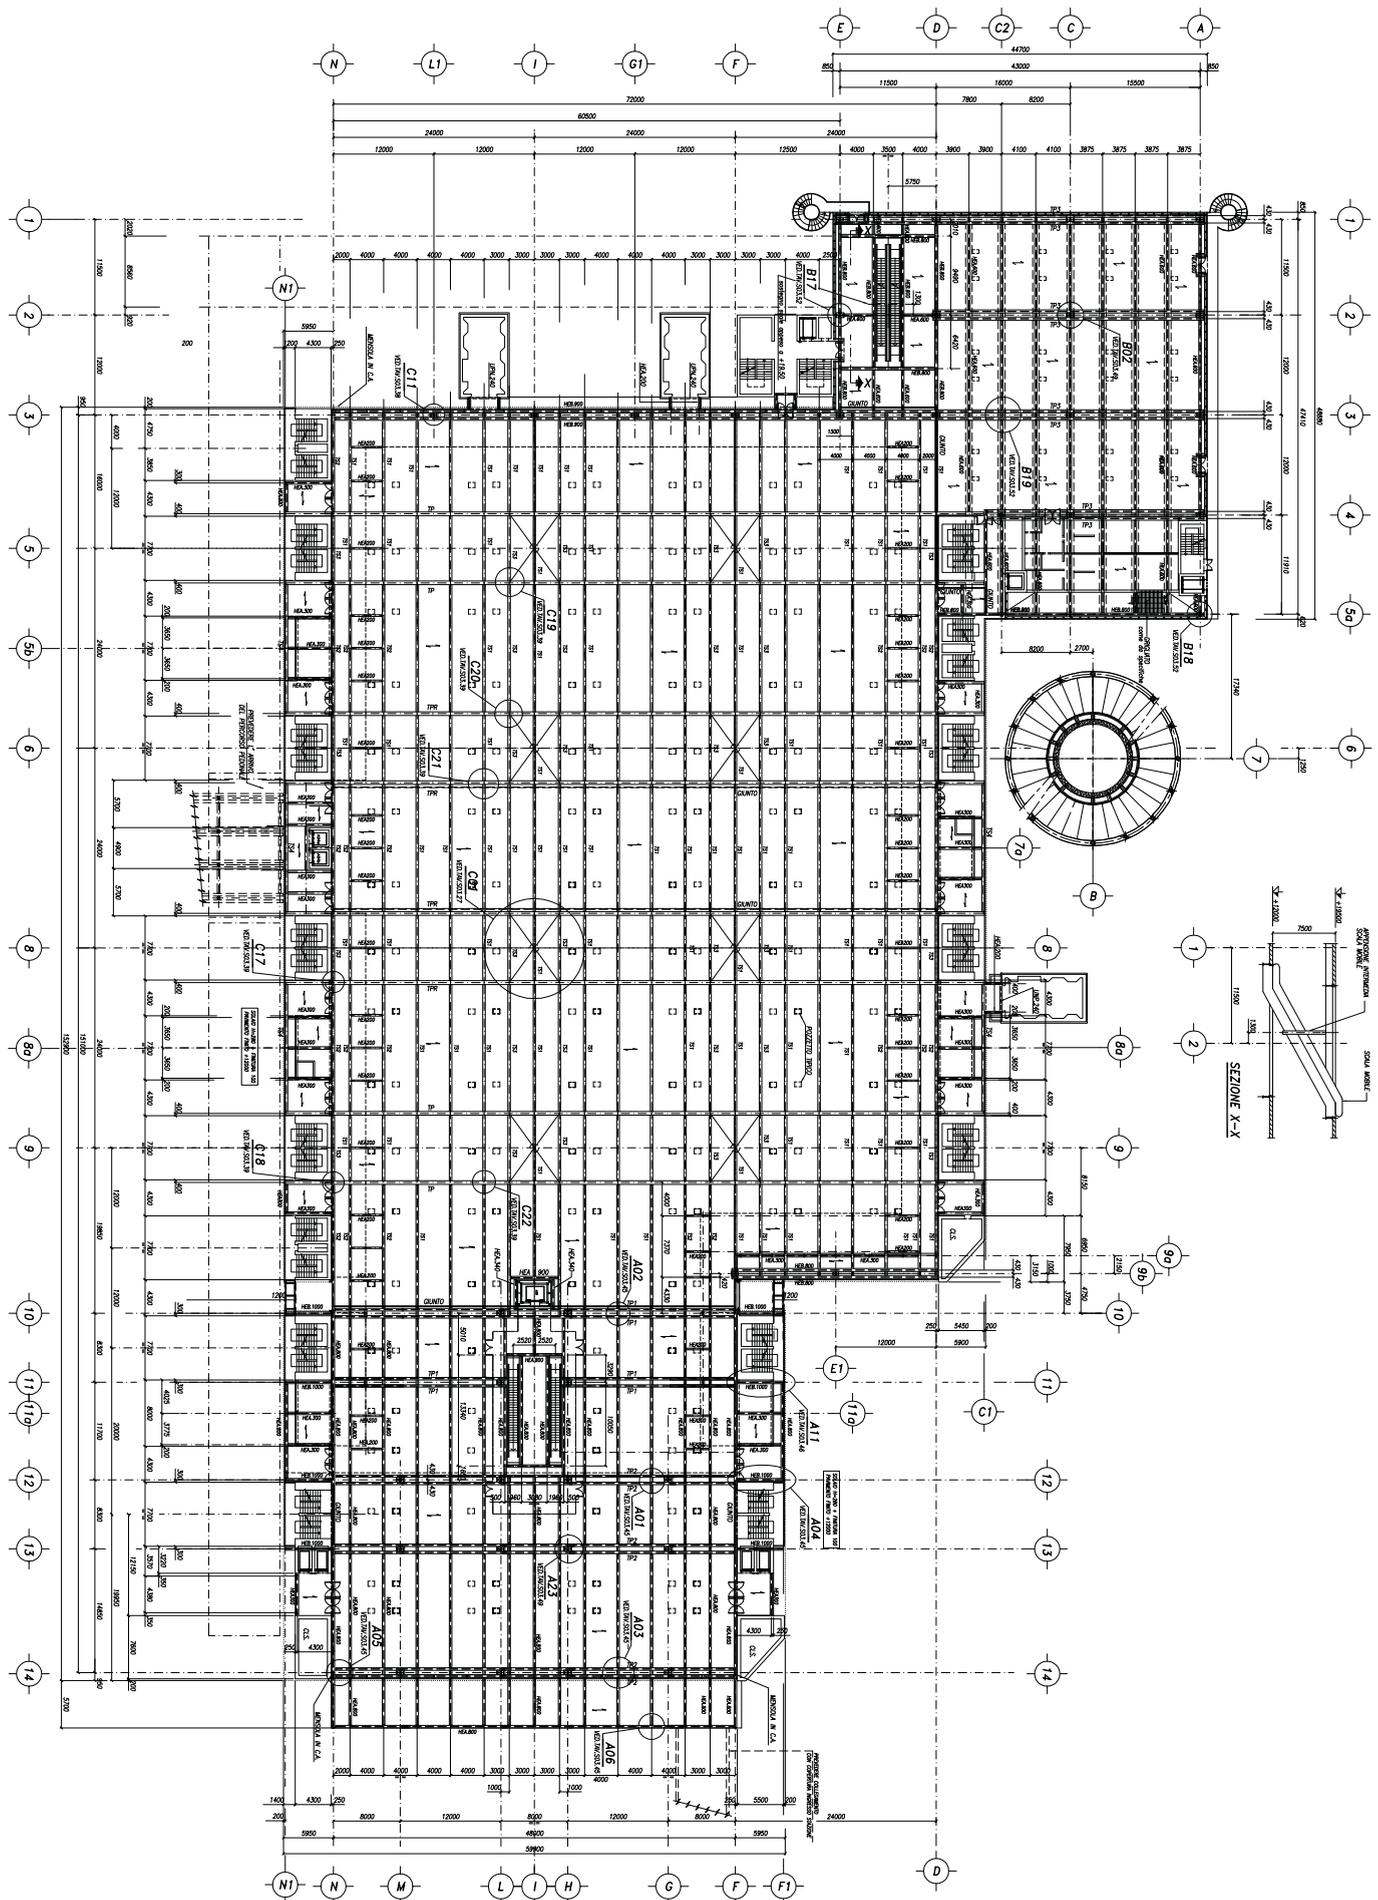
Pianta della struttura portante dell'impalcato principale a quota +12.00 m
